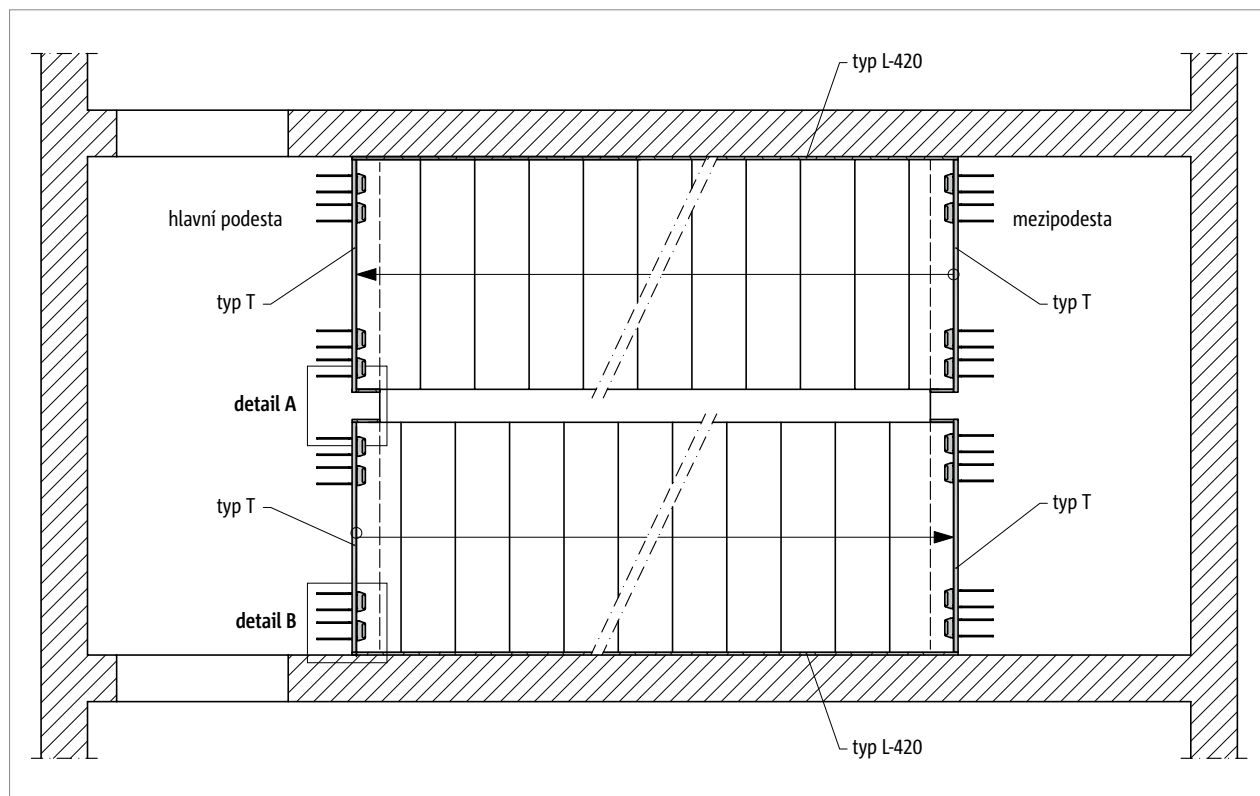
Schöck Tronsole® typ T: Řez napojením podest
